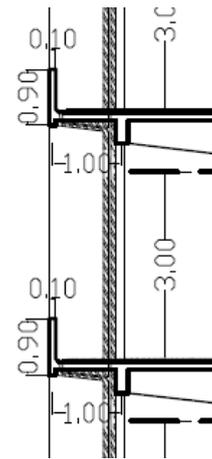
Detail *shading device* pada fasad lantai 9
